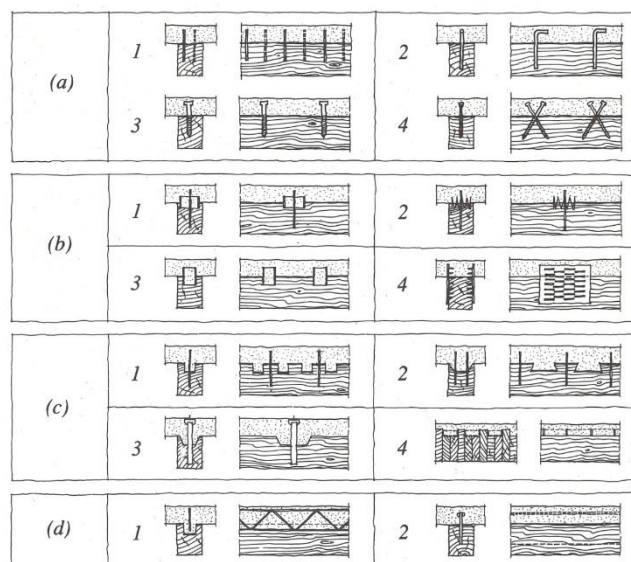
Beispiele für Holz-Beton Verbindungen: (a1) Nägel, (a2) geklebte Stahlstangen für Stahlbeton, (a3/4) Schrauben; (b1/2) Verbinder (Ringdübel und Einpressdübel), (b3) Stahlrohre, (b4) gestanzte Stahlbleche, (c1) runde Ausnehmung des Holzes, Verbindungsmittel verhindern Abheben, (c2) rechteckige Ausnehmungen, (c3) kalottenförmige Ausnehmung mit vorgespannten Stahlstangen, (c4) Brettstapelverbindung und Stahlbleche in unteren Brettern, (d1) ins Holz geklebte Stahlgitter, (d2) ins Holz geklebte Stahlbleche [64]
